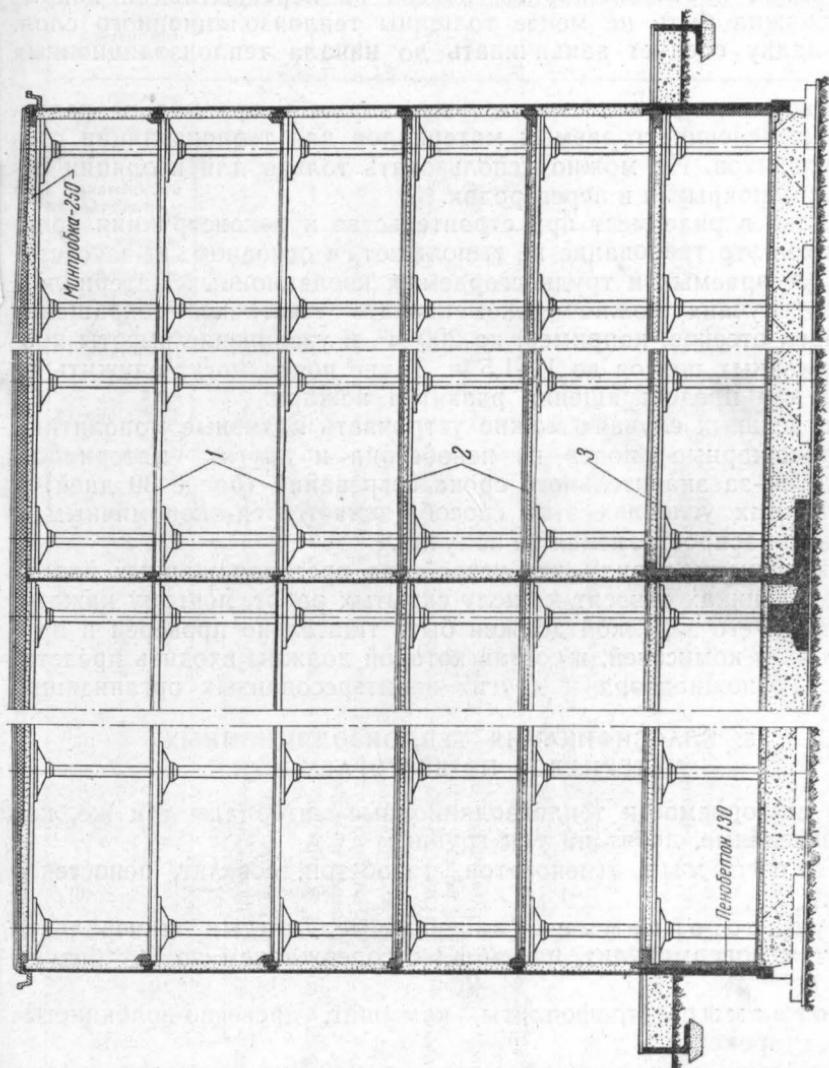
Устройство противопожарных поясов у наружных и внутренних стен.
